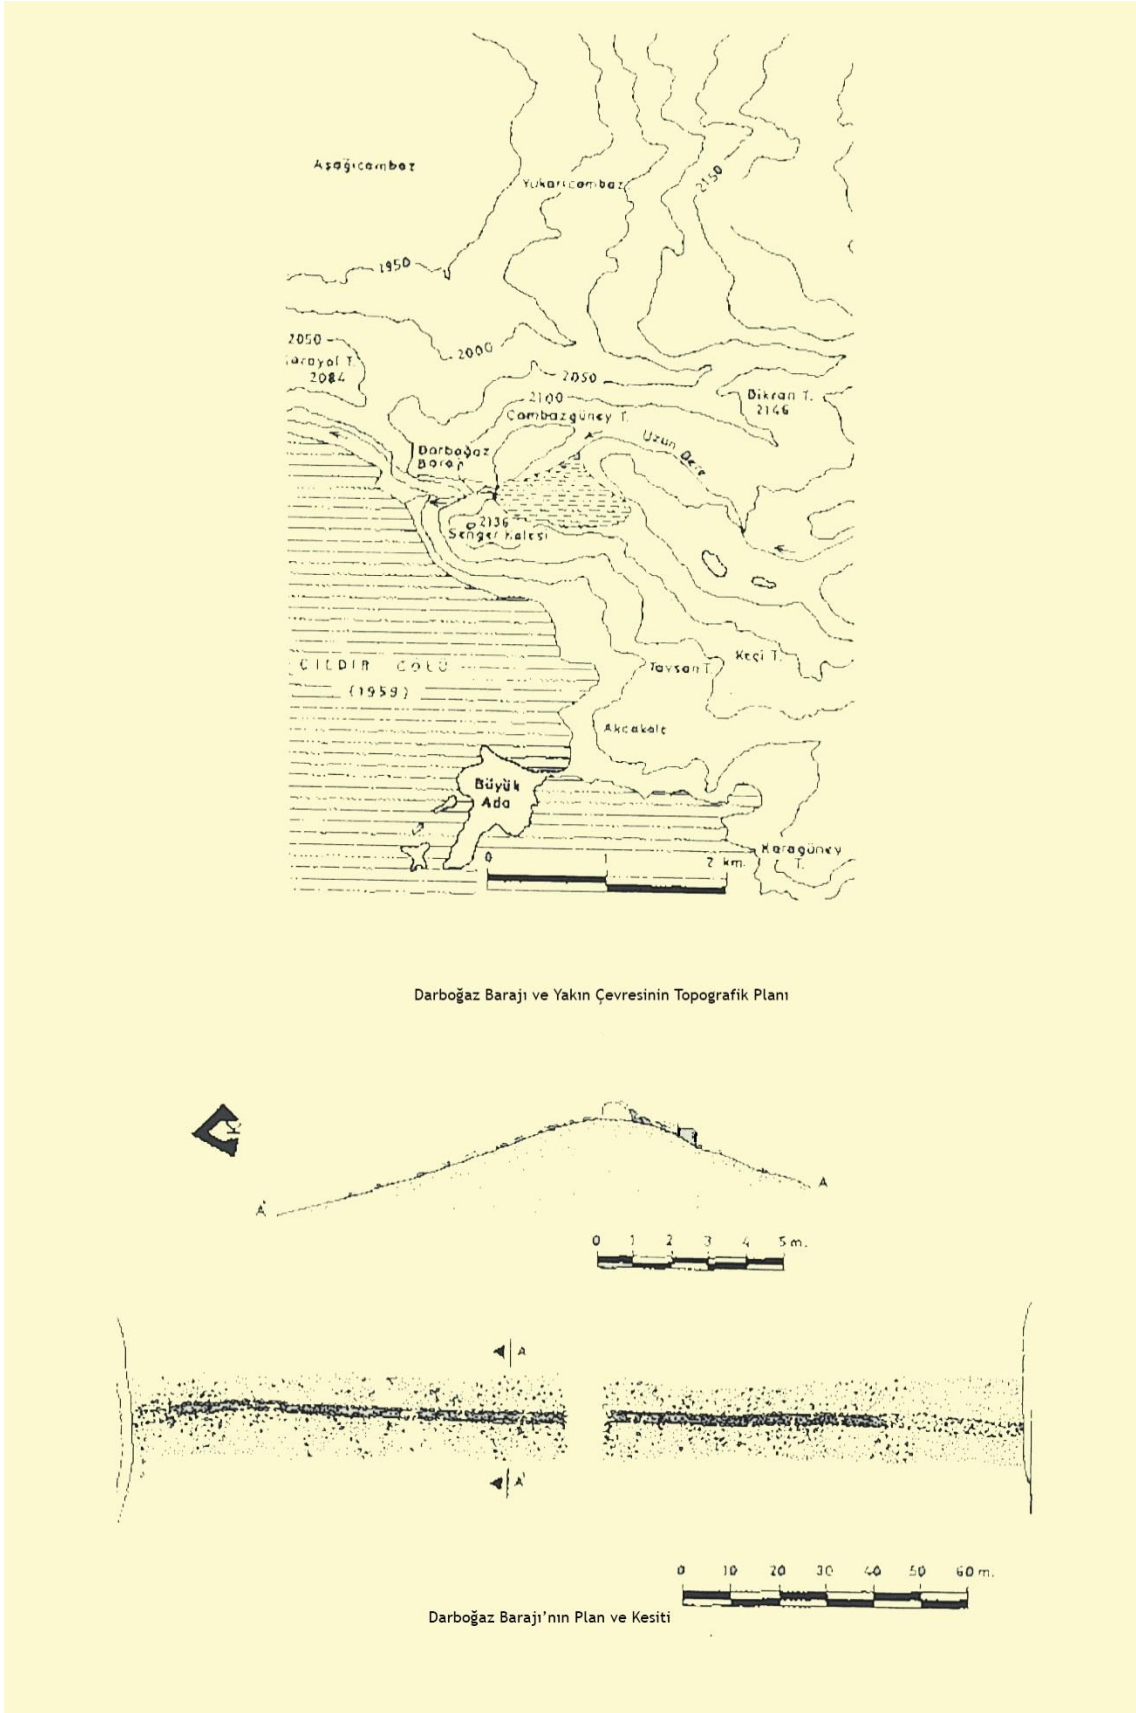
Darboğaz Barajı'nın Plan ve Kesiti (Bellı, 1999)
